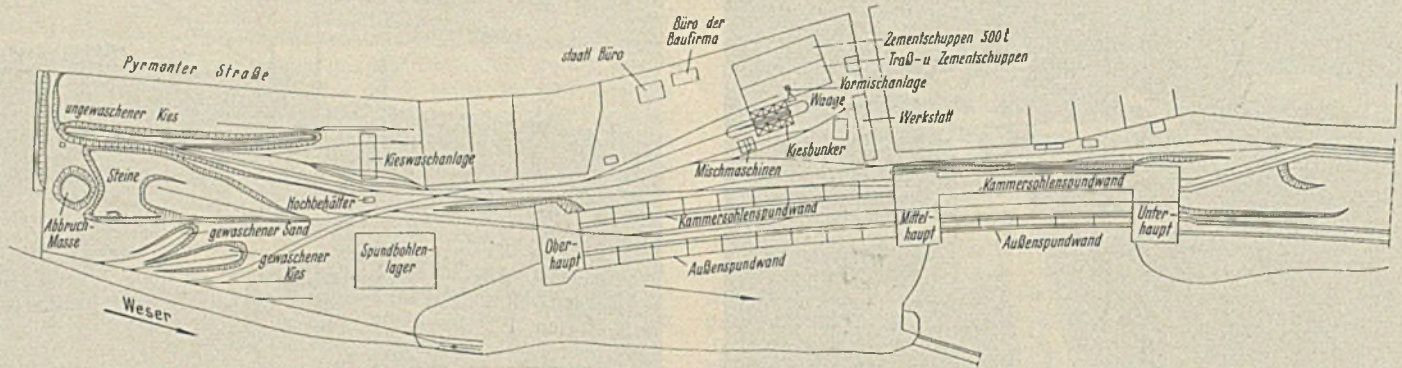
Baustelleneinrichtung der Schleppzugschleuse Hameln.
